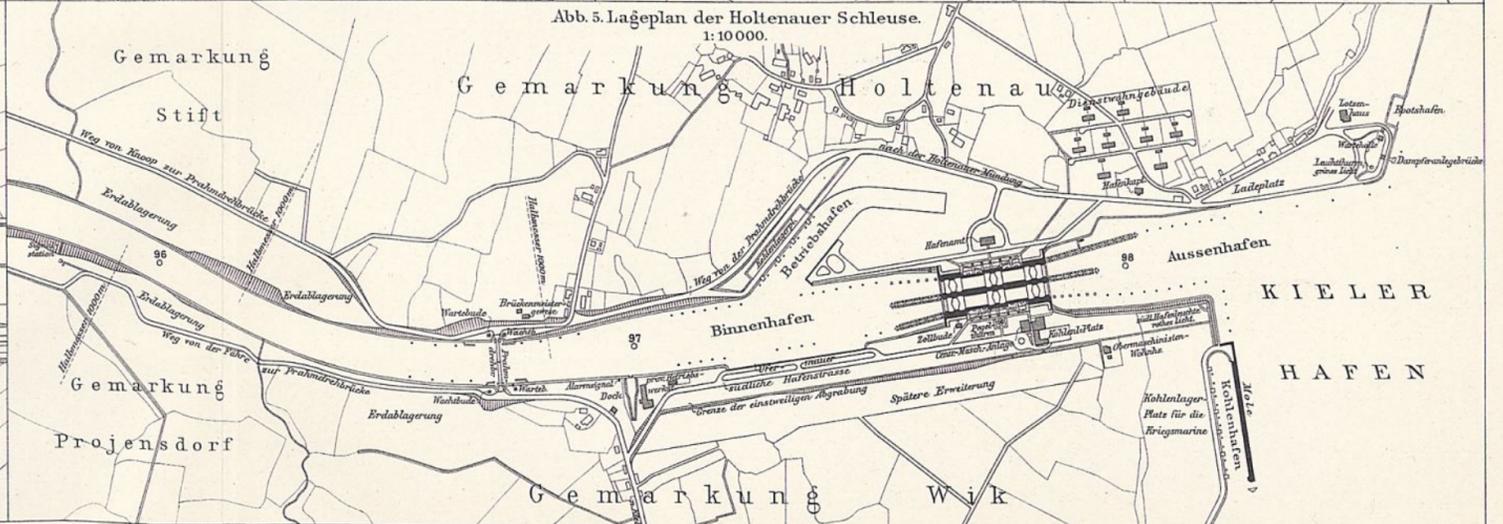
Lageplan der Holtener Schleuse. 1:10 000.
